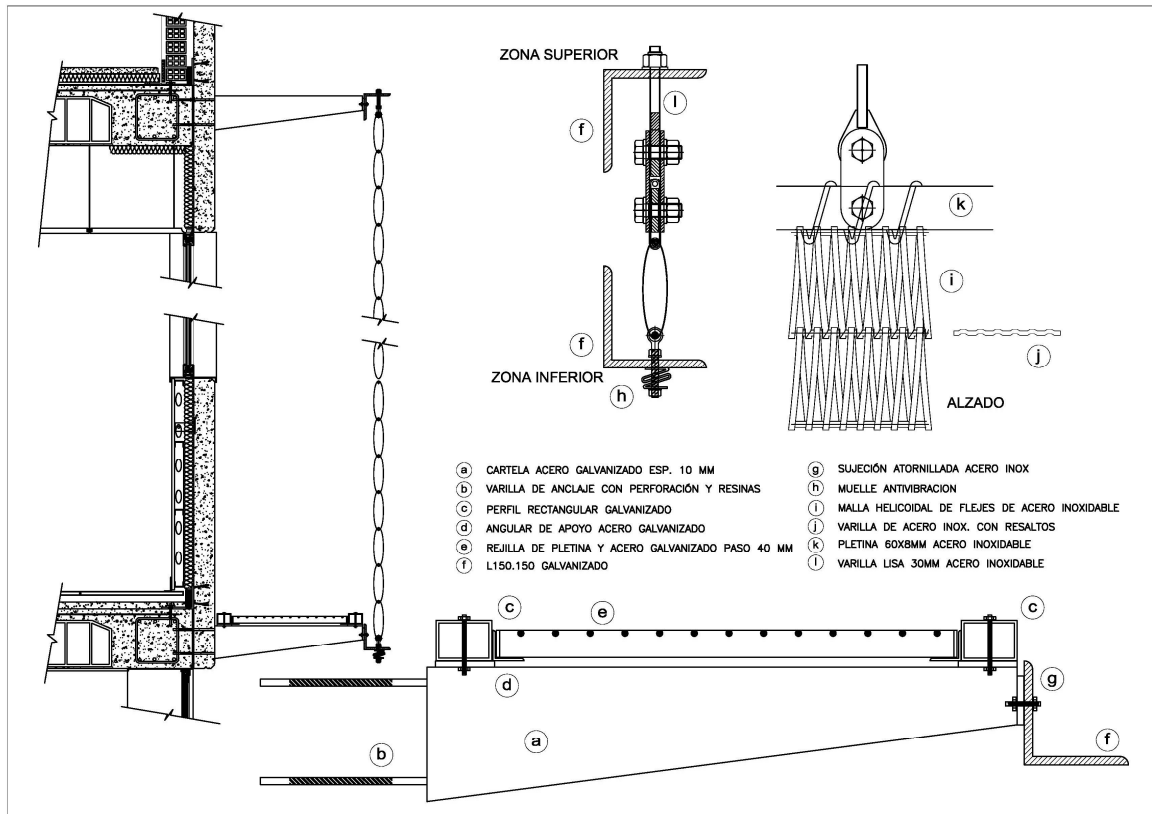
Detalle constructivo Malla exterior y pasarela (Proyecto)
